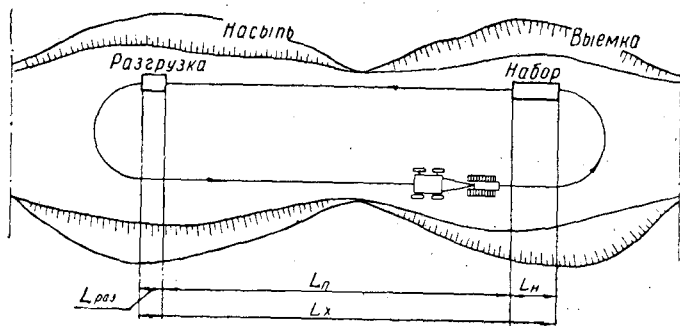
7. Схема разработки грунта в выемке и перемещения ее в насыпь скрепером Д-222
